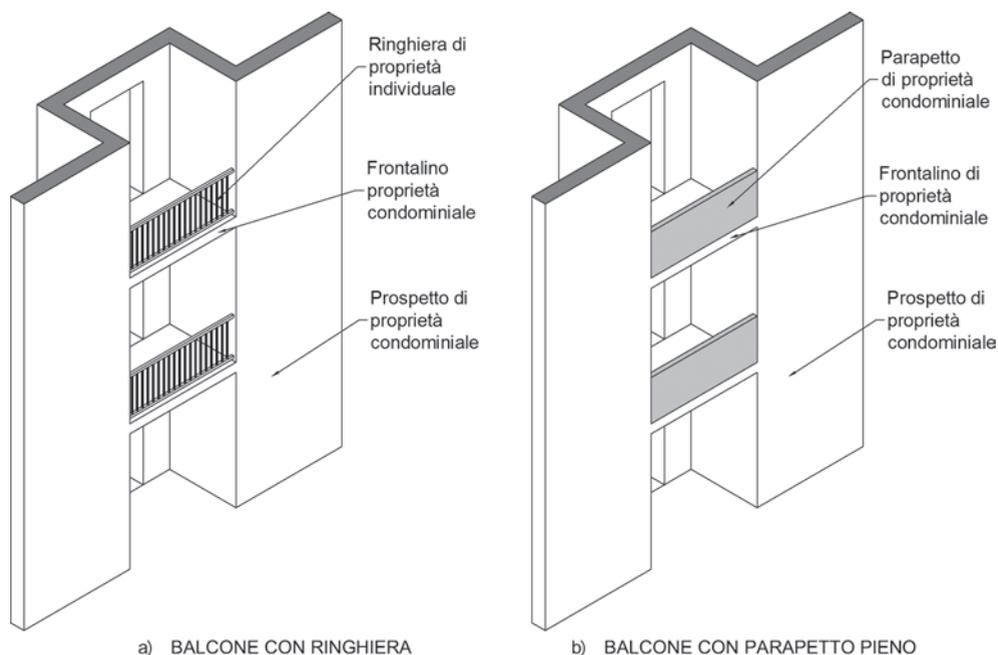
Tipologie di parapetti per balcone incassato: a) balcone delimitato da ringhiera; b) balcone delimitato da parapetto pieno in muratura o in c.a.
